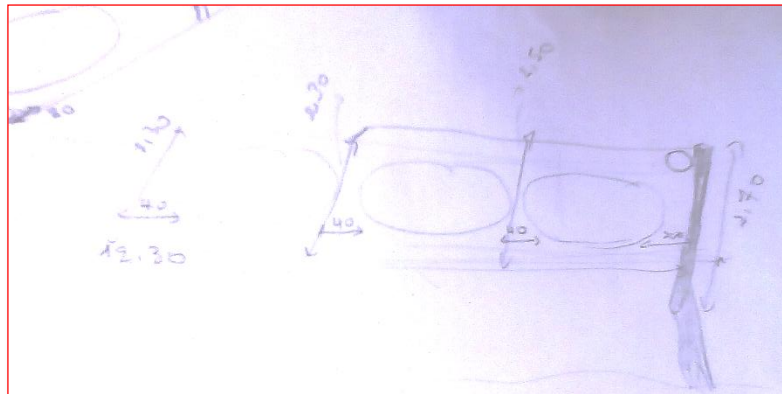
les minutes du plan de toiture. (Source : Auteur / 2017)
